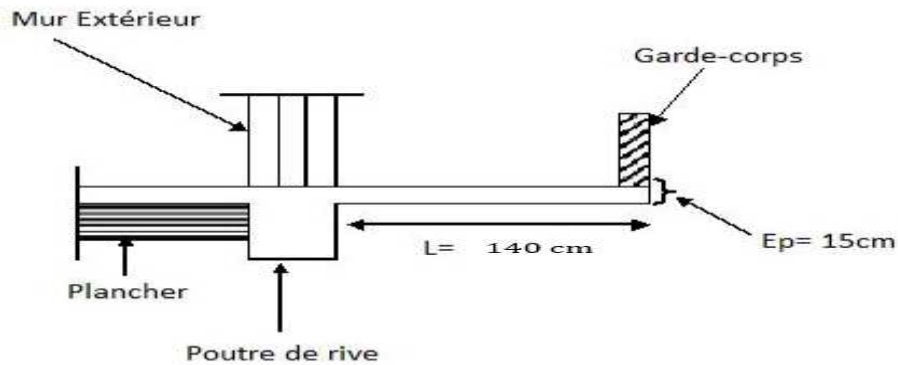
Coupe verticale détaillant la liaison balcon – poutre.
